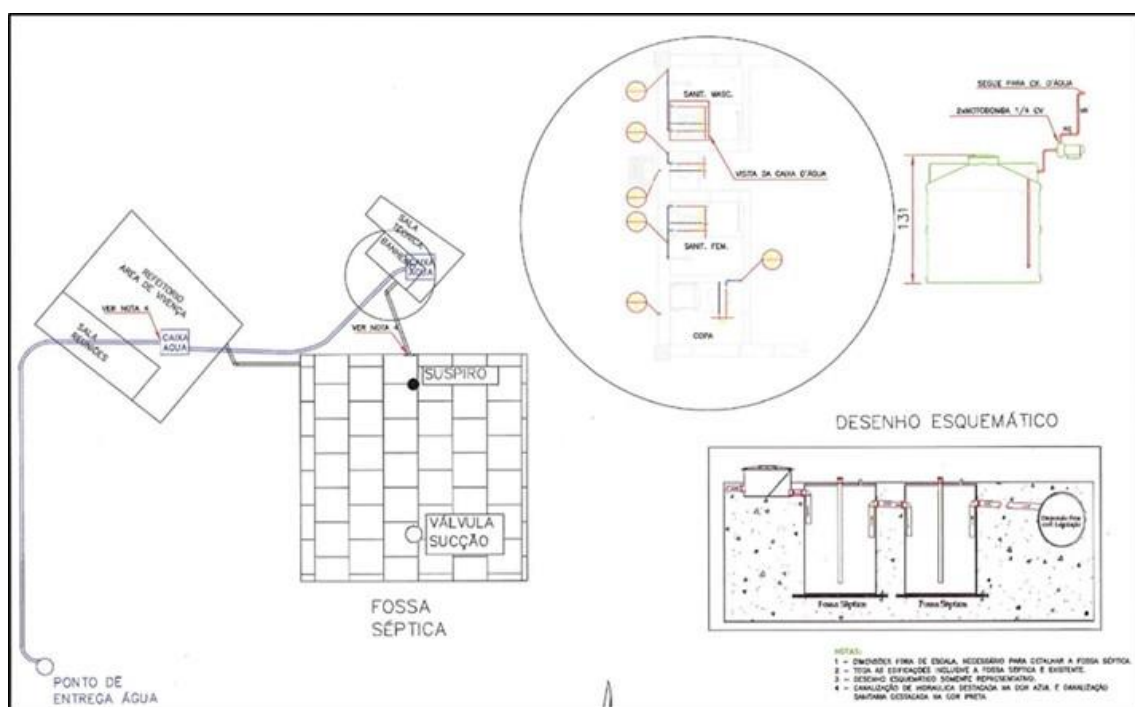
Esquema de planta hidrossanitária de canteiros de obras.
